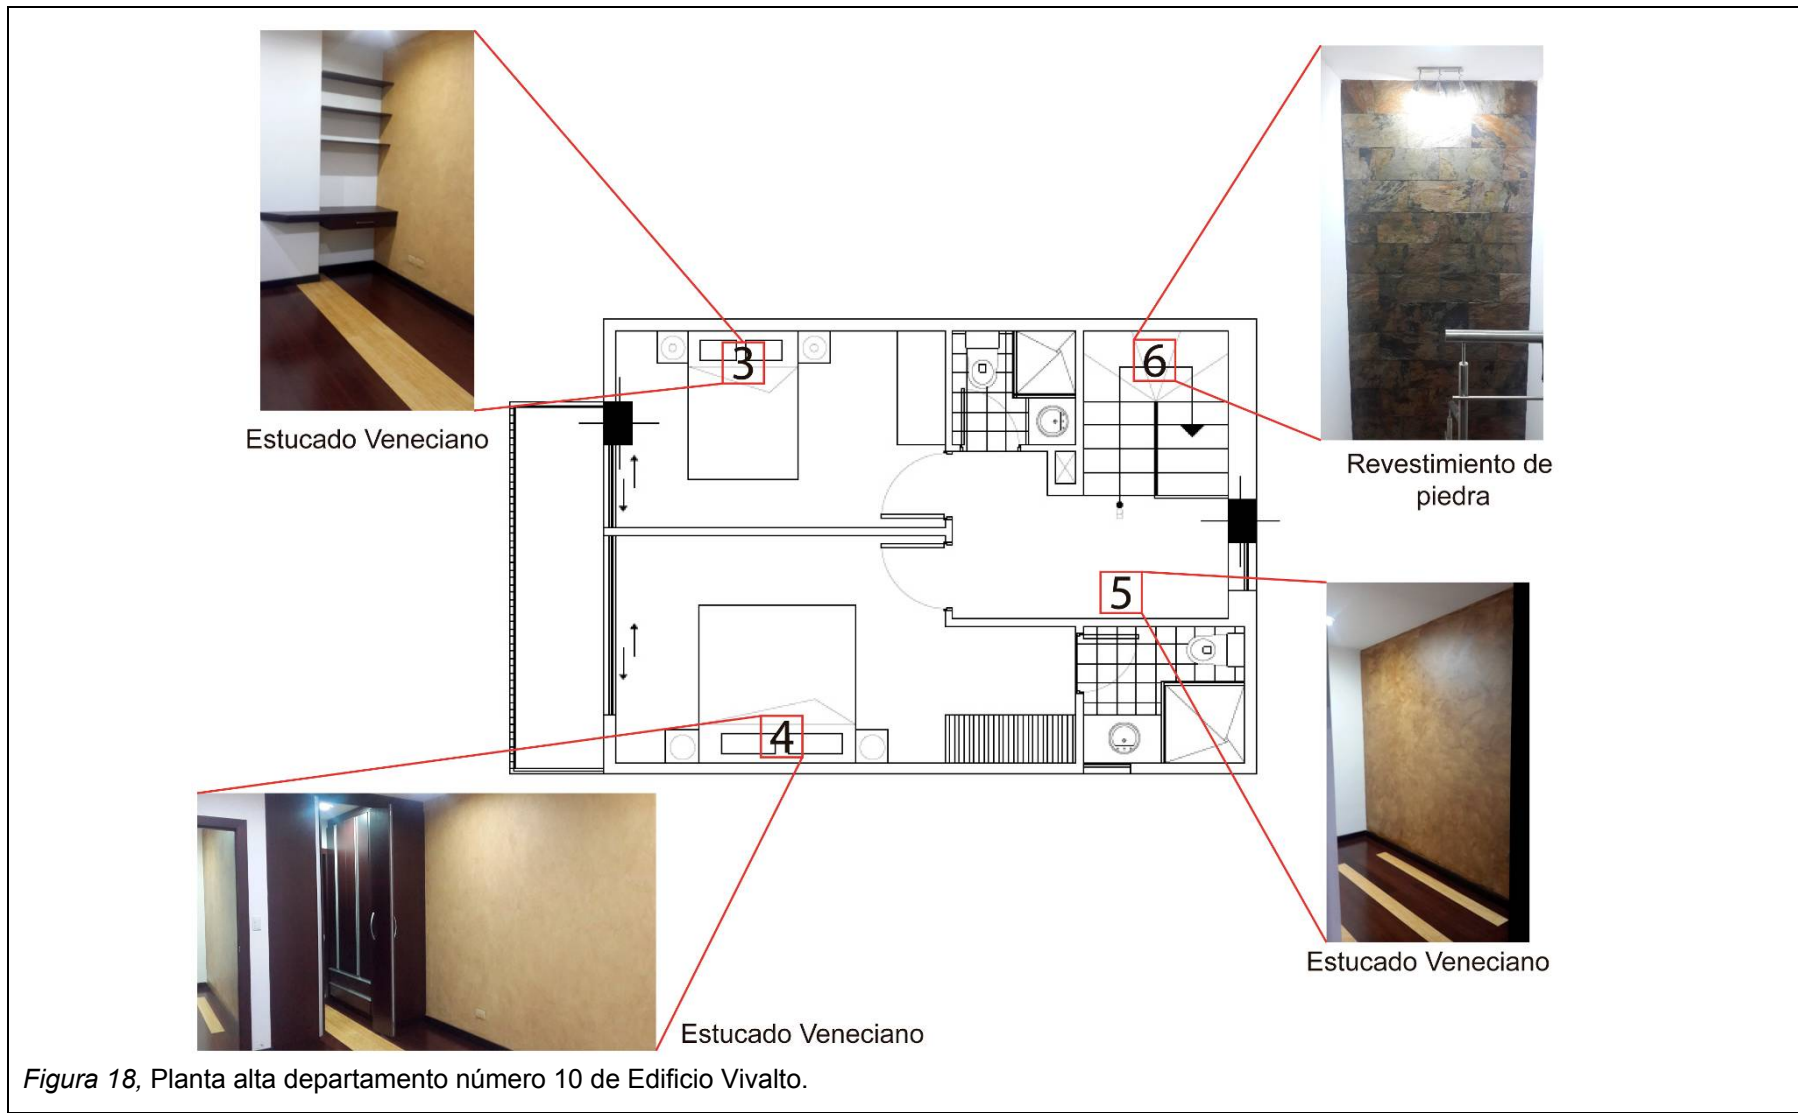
, Planta alta departamento número 10 de Edificio Vivalto.
